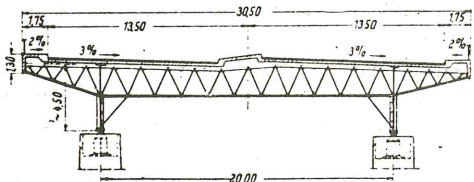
El tablero del puente de la figura anterior tiene una anchura total de 30 m y está formado por dos vigas principales, de 4,50 m de canto, separadas 20 m entre ejes. Tanto las vigas principales como las celosías secundarias son piezas mixtas, con pretensado longitudinal y transversal del tablero. El pretensado se introdujo una vez enlazado el tablero a las vigas.
